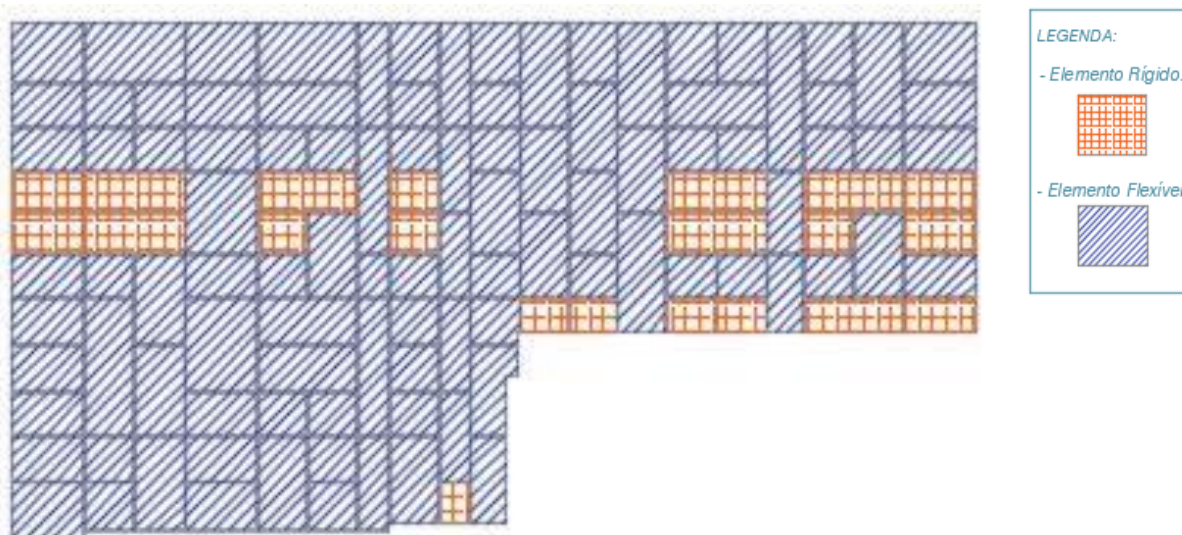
Elementos rígidos/flexíveis identificados na fachada
